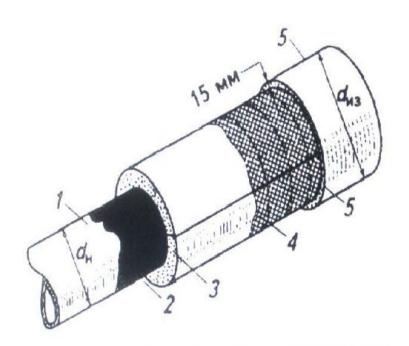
Подвесная теплоизоляционная конструкция 1 – труба; 2 – антикоррозийное покрытие; 3 – мат из минеральной ваты; 4 – стальная сетка; 5 – асбестоцементная штукатурка
